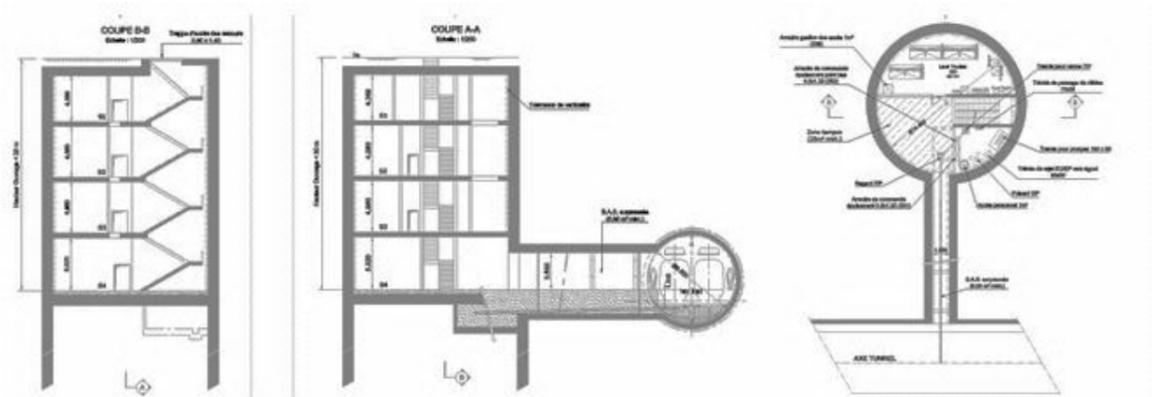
Coupe et vue en plan niveau cheminement OA accès secours et d'épuisement circulaires
